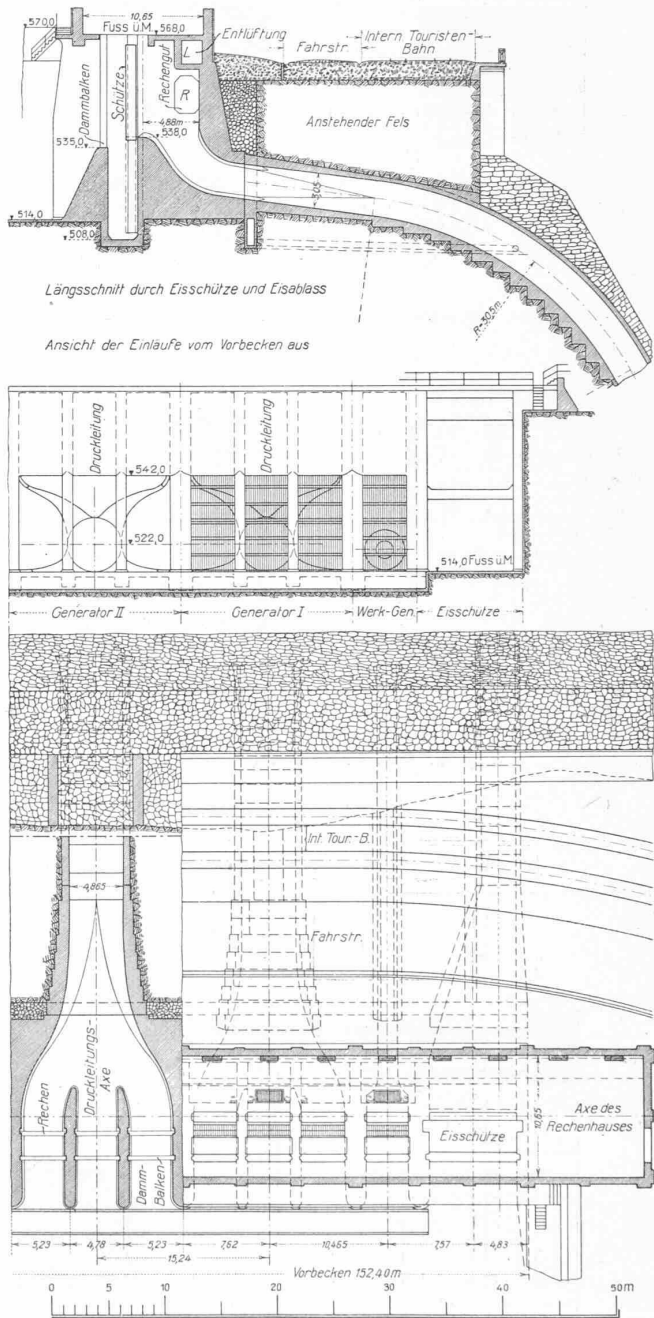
Grundrisse und Schnitte des Rechenhauses mit Einlauf in die Druckleitungen; oben Schnitt durch Eisschütze und Eisablassrohr. Masstab 1 : 600.
